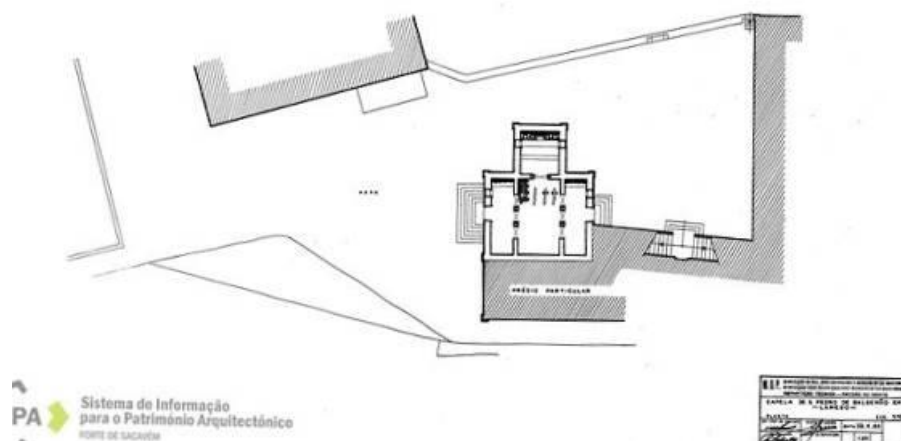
Planta da Capela de São Pedro de Balsemão<sup>596</sup>. Capela adossada parcialmente à casa dos Viscondes de Balsemão. O Prédio Particular adjacente na planta corresponde ao solar dos Viscondes de Balsemão.
